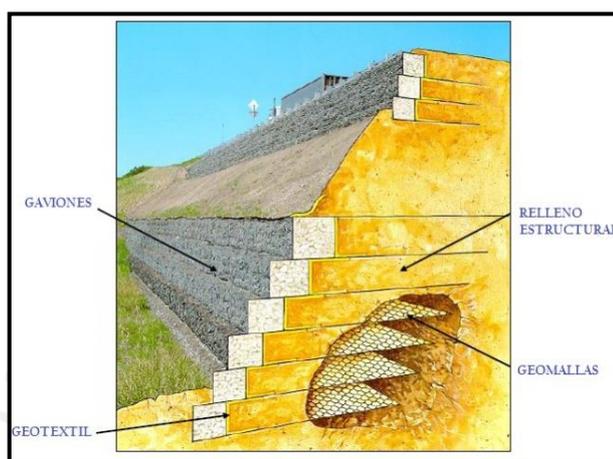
Detalle de muro de suelo reforzado - Terramesh System
